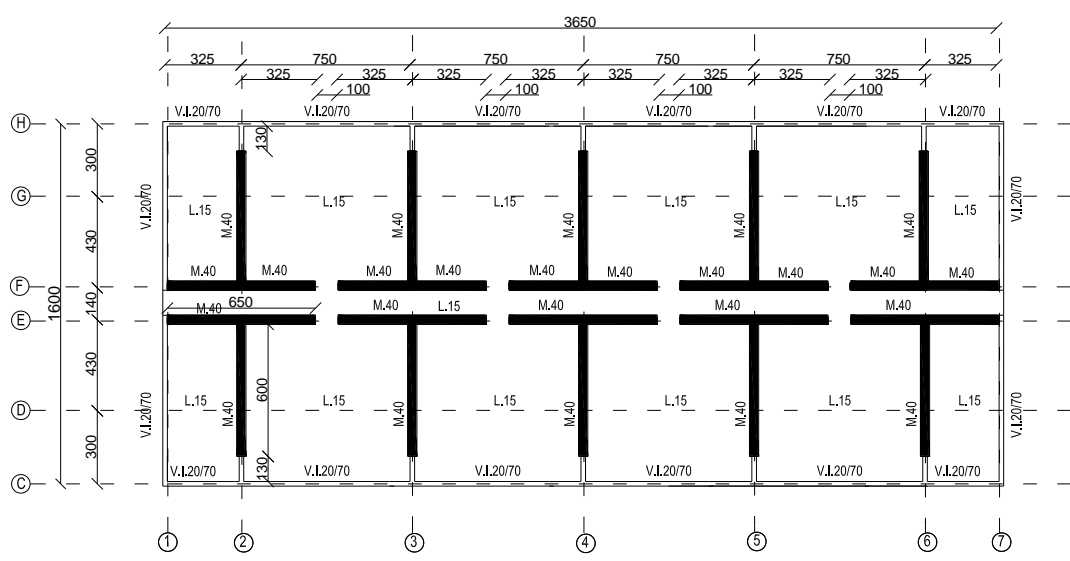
Planta estructura nivel 2º-11º, edificio tradicional.
